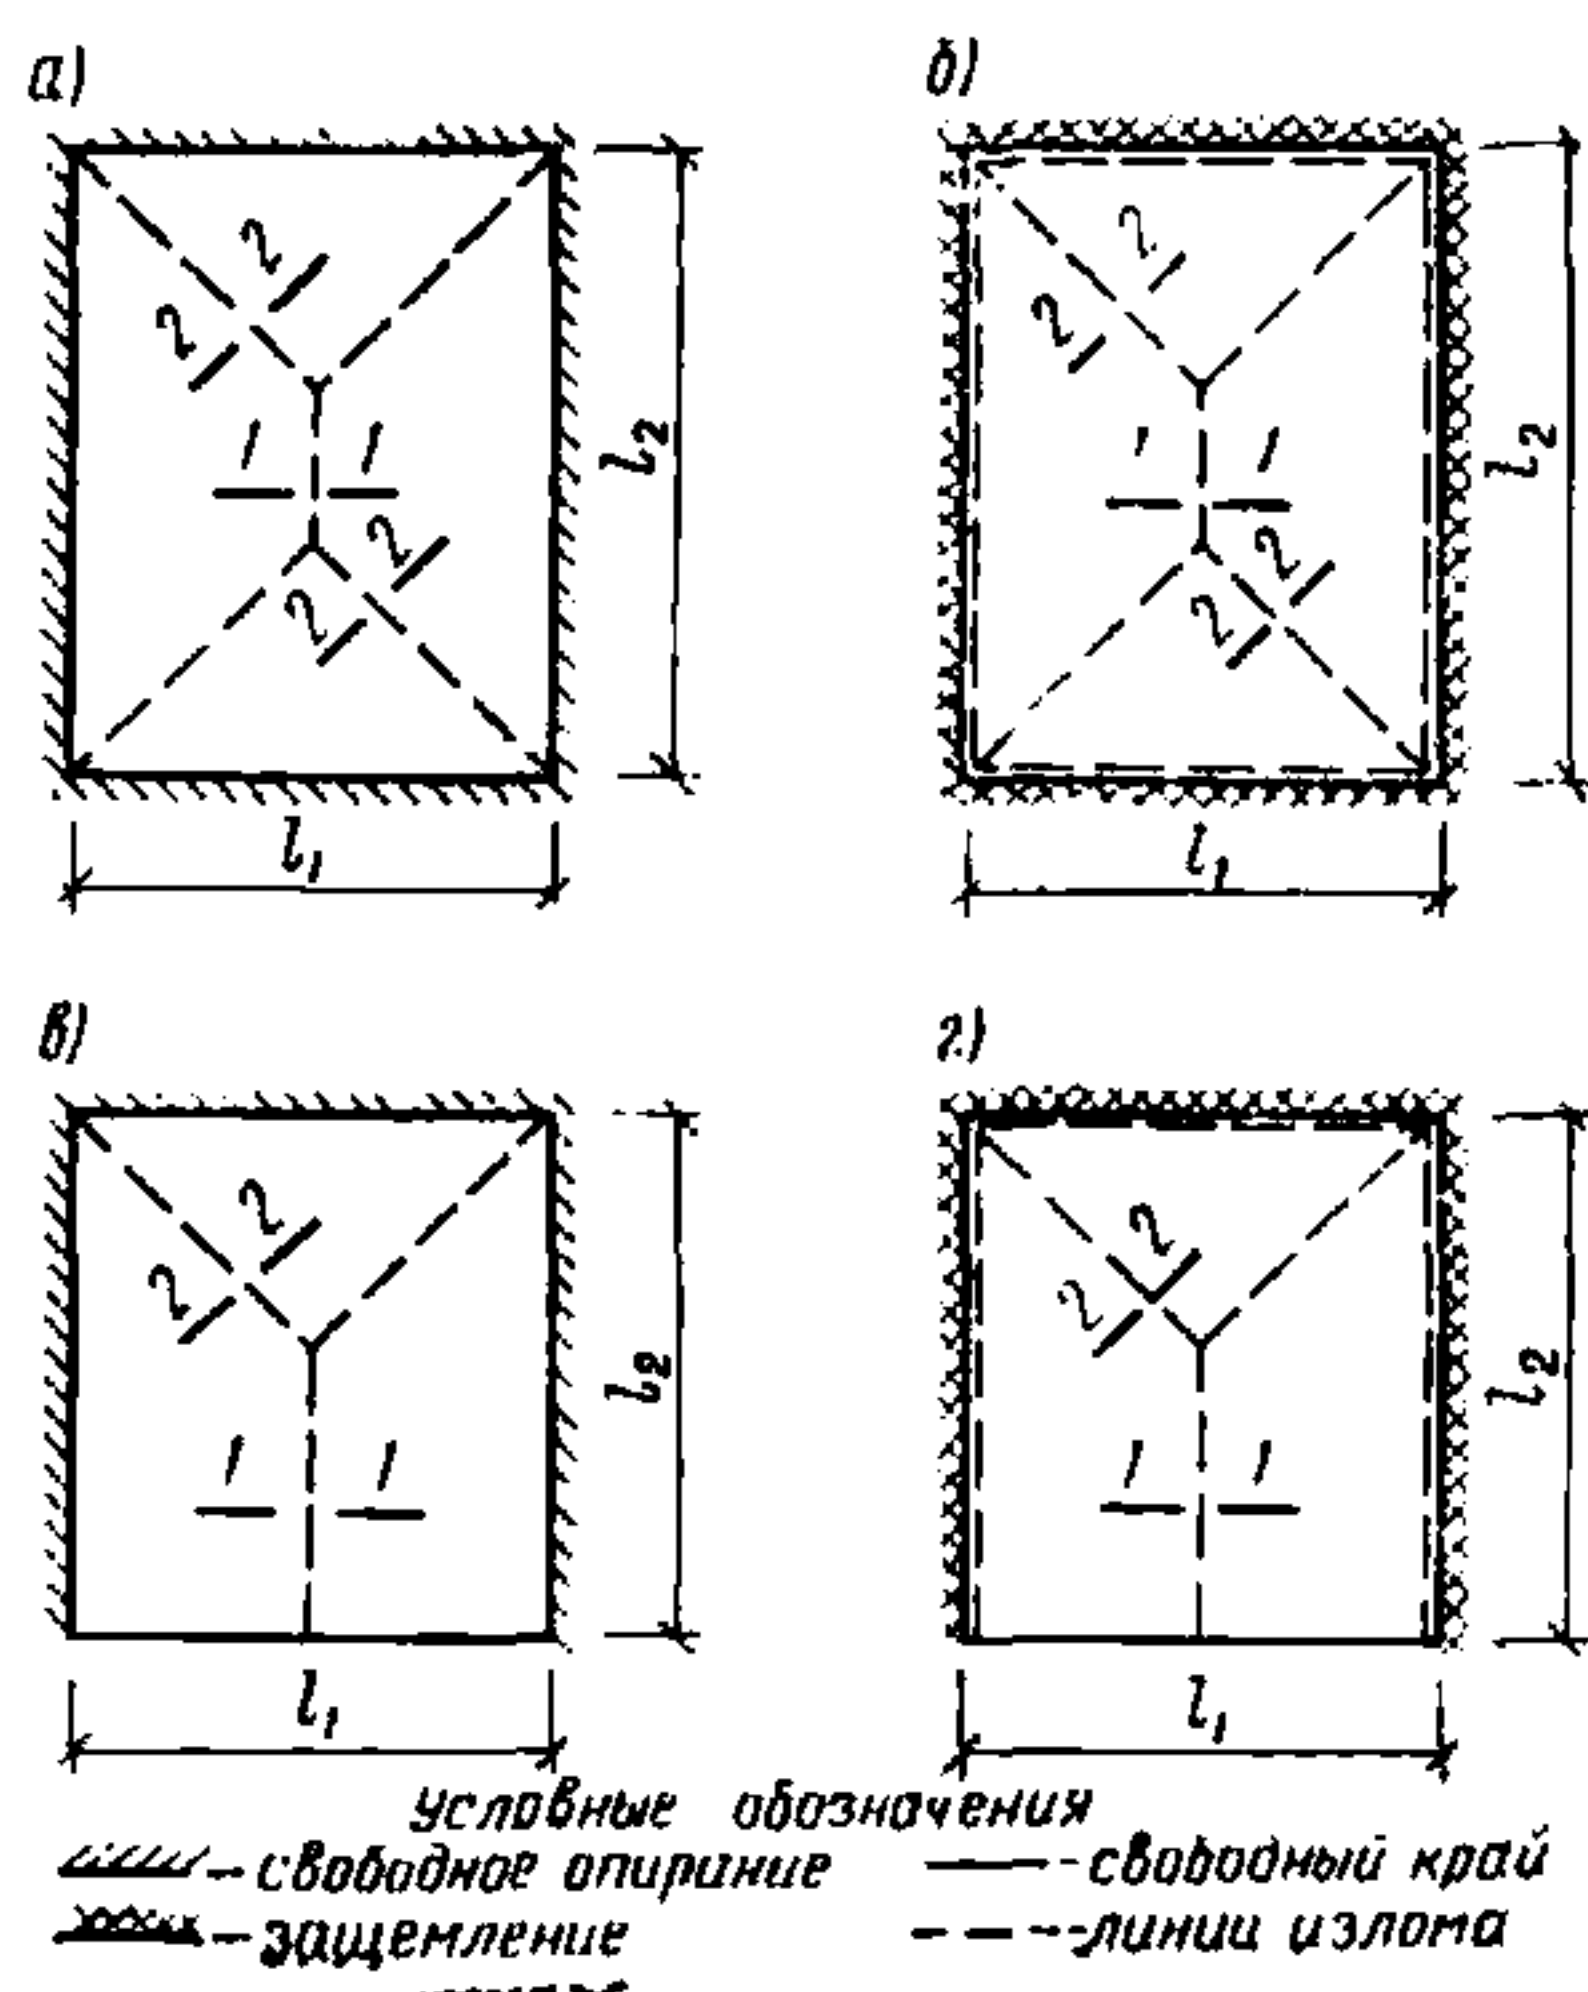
Схема излома плит перекрытий, работающих в двух направлениях, и расчетные сечения при определении нагрузки образования трещин в пролете
